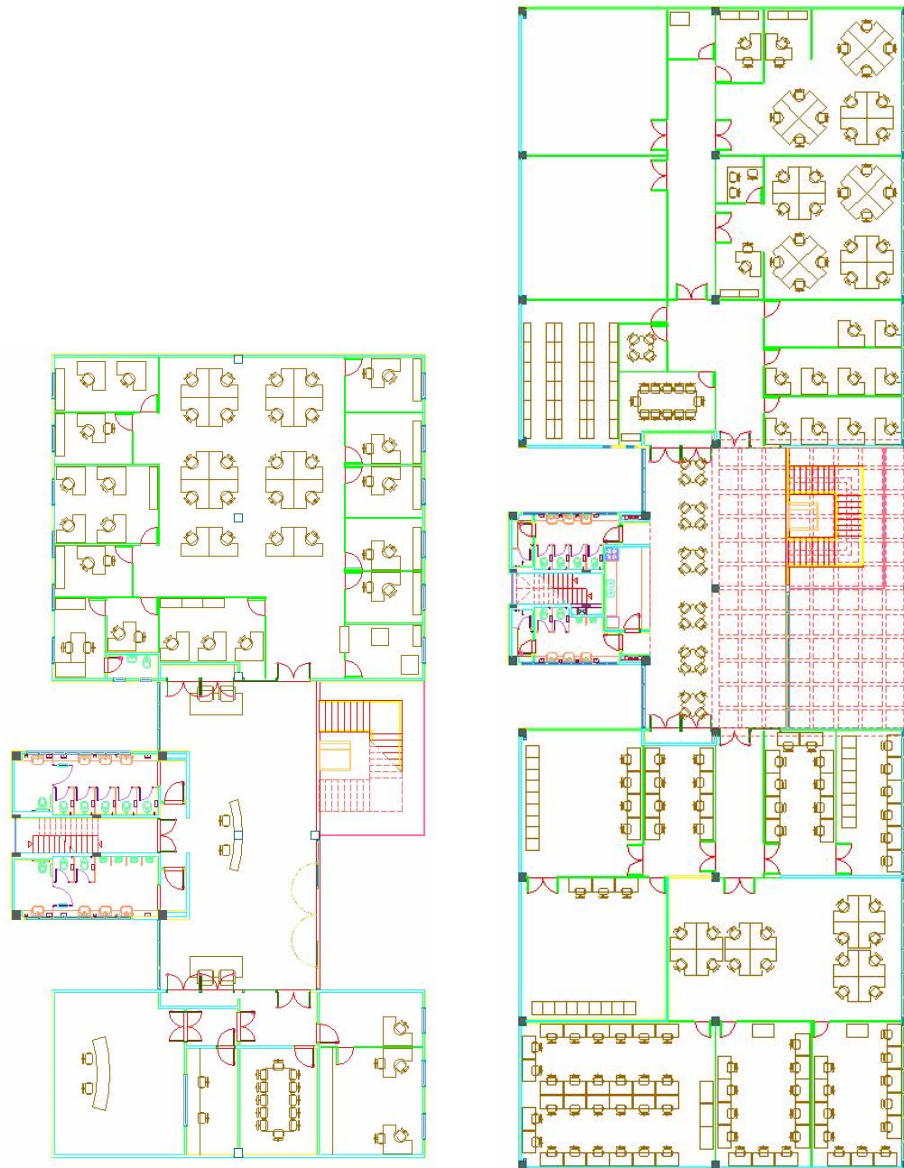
Plantas baixas do prédio do NTI/CPD da UnB (esquerda: pavimento térreo)
